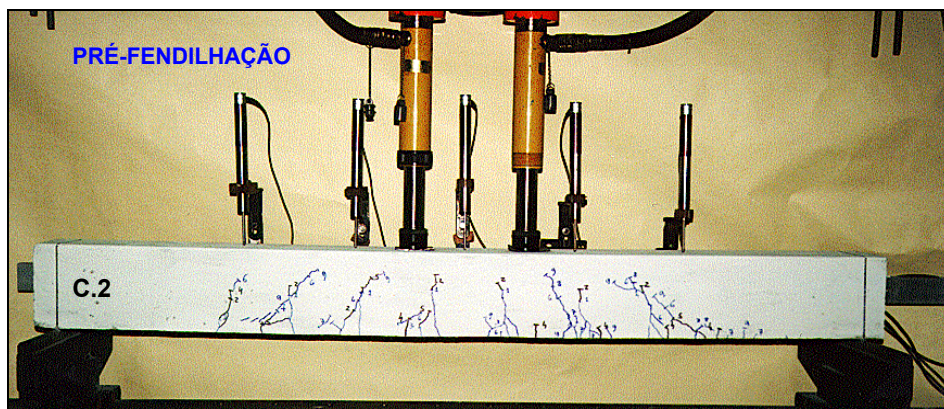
Aspecto geral da pré-fendilhação da *viga C.2* (1ª fase).
